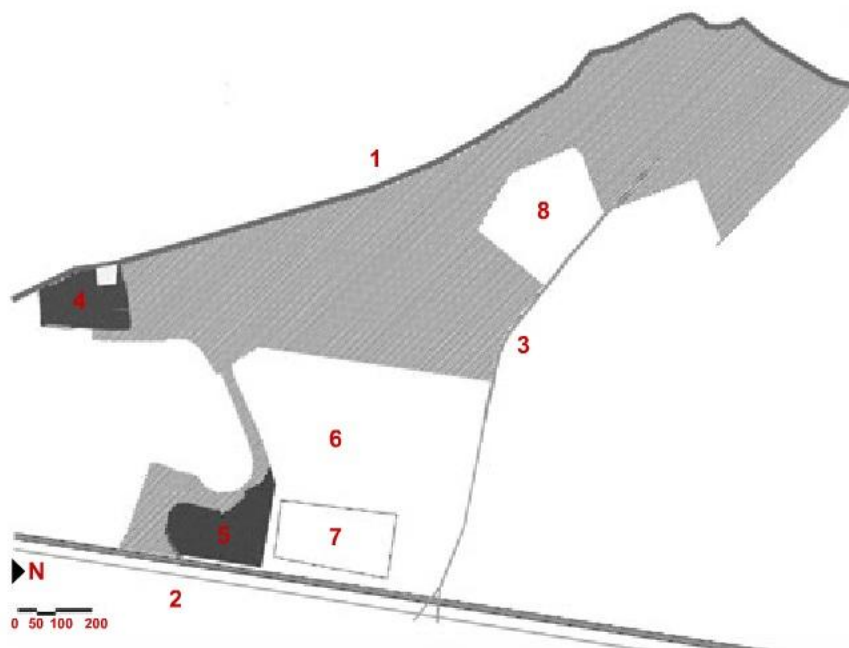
A - CONCURSO NACIONAL DE ARQUITETURA - PROJETO ARQUITETÔNICO -
